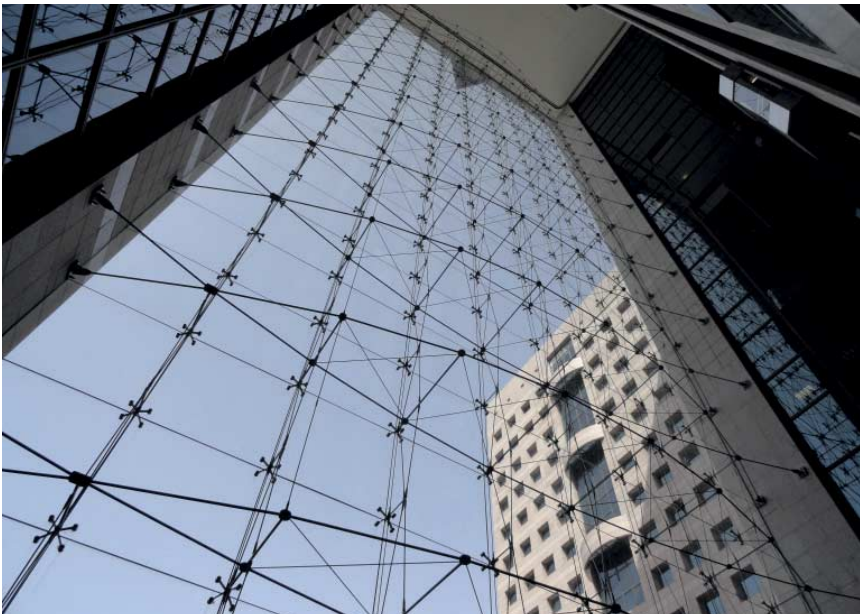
De 52 m hoge en 16 m brede kozijnloze glasgevel voor het OZ gebouw in Ramat Gan, Israel. De wind wordt horizontaal afgedragen per 3,6 m op elke verdiepingvloer; het eigengewicht wordt via hangstaven naar de dakconstructie overgedragen, [arch Avram Yaski]
